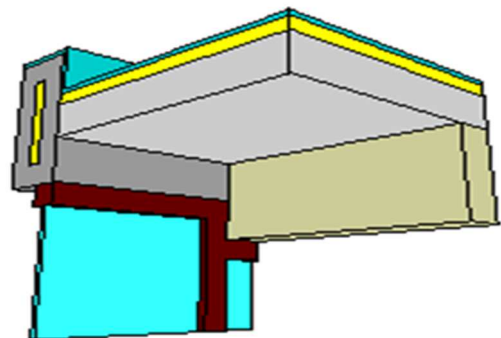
Ponte térmica entre o vão exterior e o pavimento elevado antes da simulação
